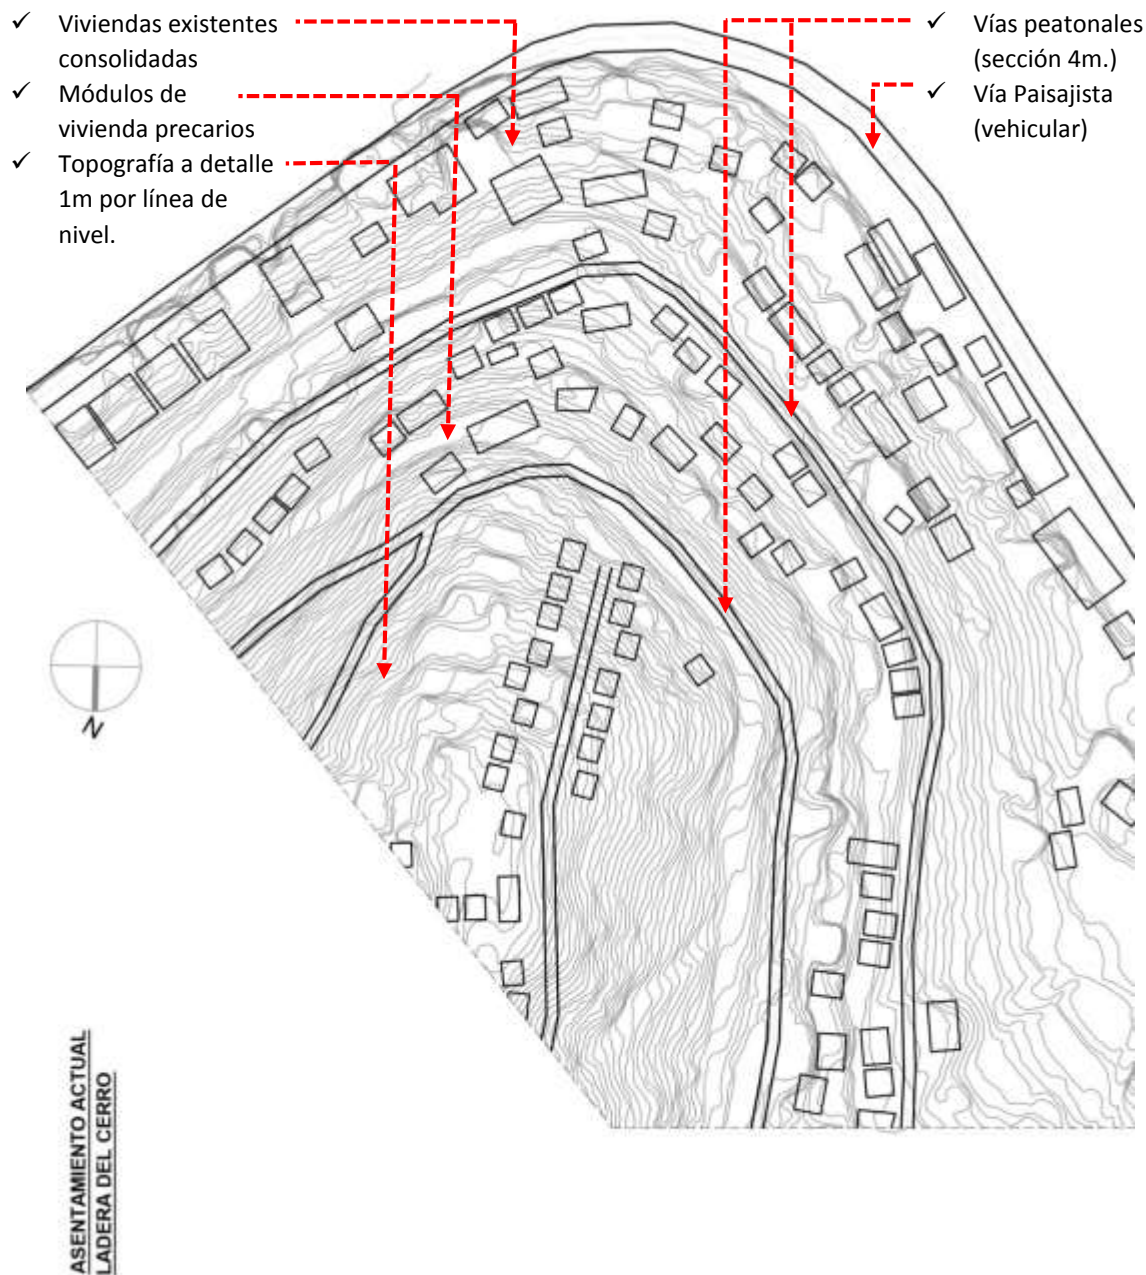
Levantamiento a detalle del área de intervención – “Cerro” Sector crítico
